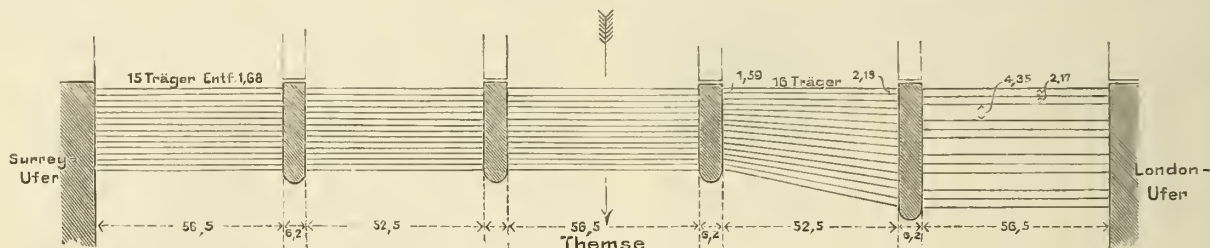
Grundriss der neuen Eisenbahnbrücke.
